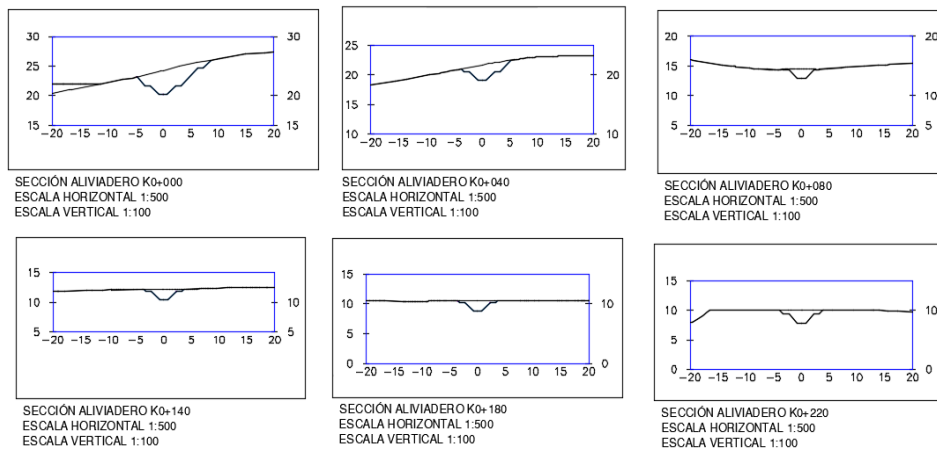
Vistas seccionales del aliviadero. Fuente: Fernando Mite (2022)
